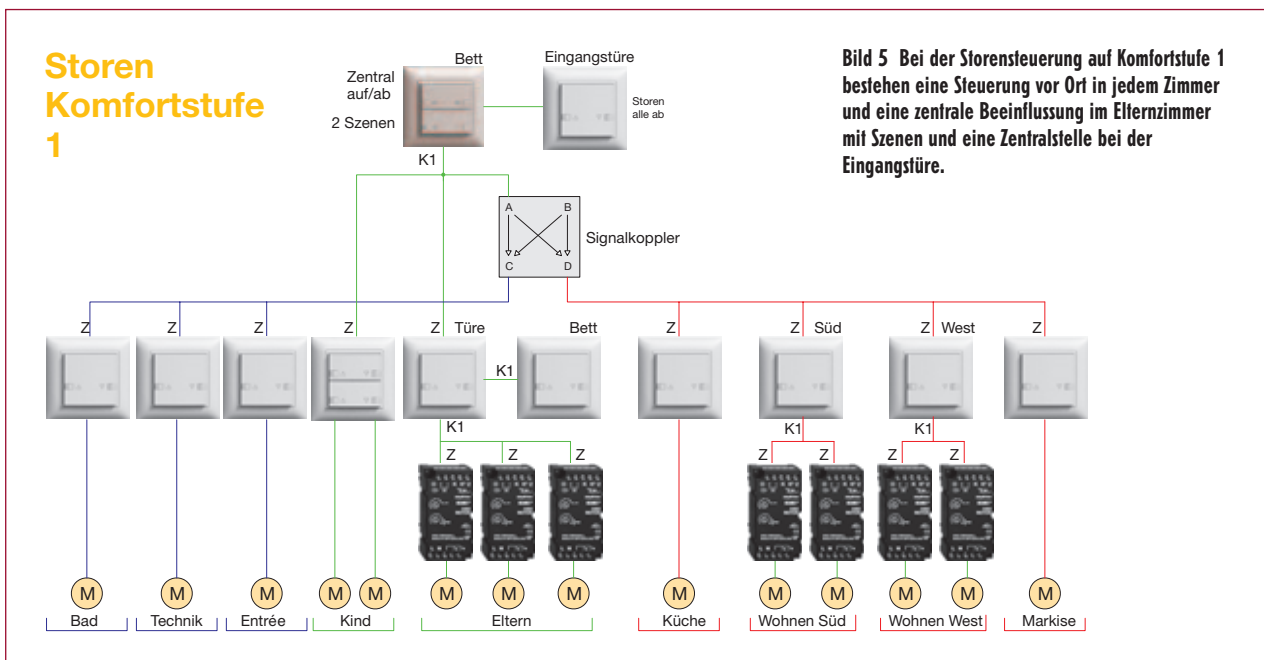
Bei der Störensteuerung auf Komfortstufe 1 bestehen eine Steuerung vor Ort in jedem Zimmer und eine zentrale Beeinflussung im Elternzimmer mit Szenen und eine Zentralstelle bei der Eingangstüre.
